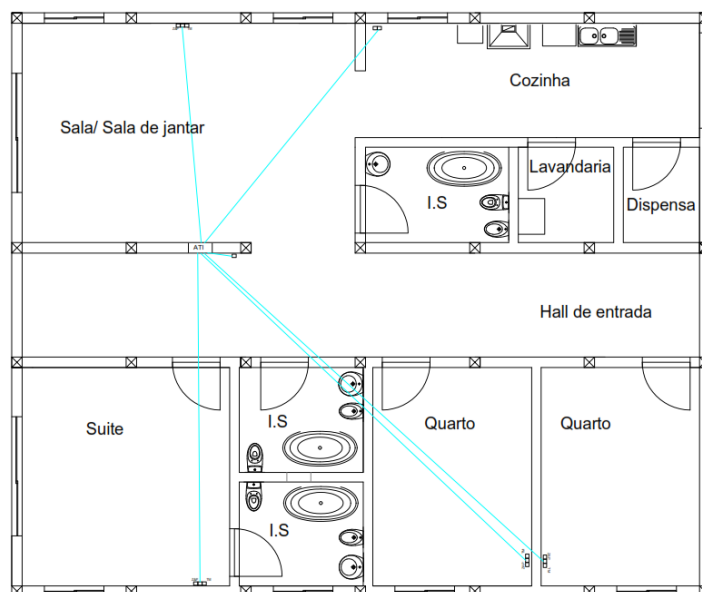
Planta do traçado da rede ITED, da solução 1, 1º piso
